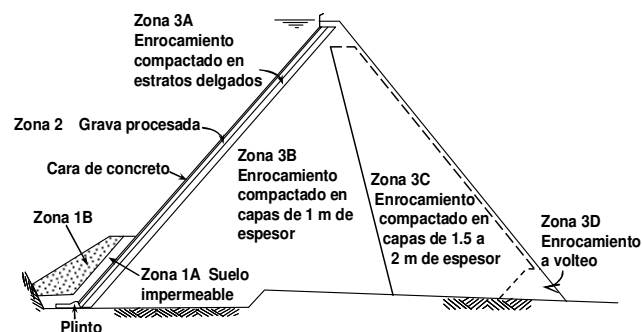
Sección típica de presas de enrocamiento con cara de concreto.
